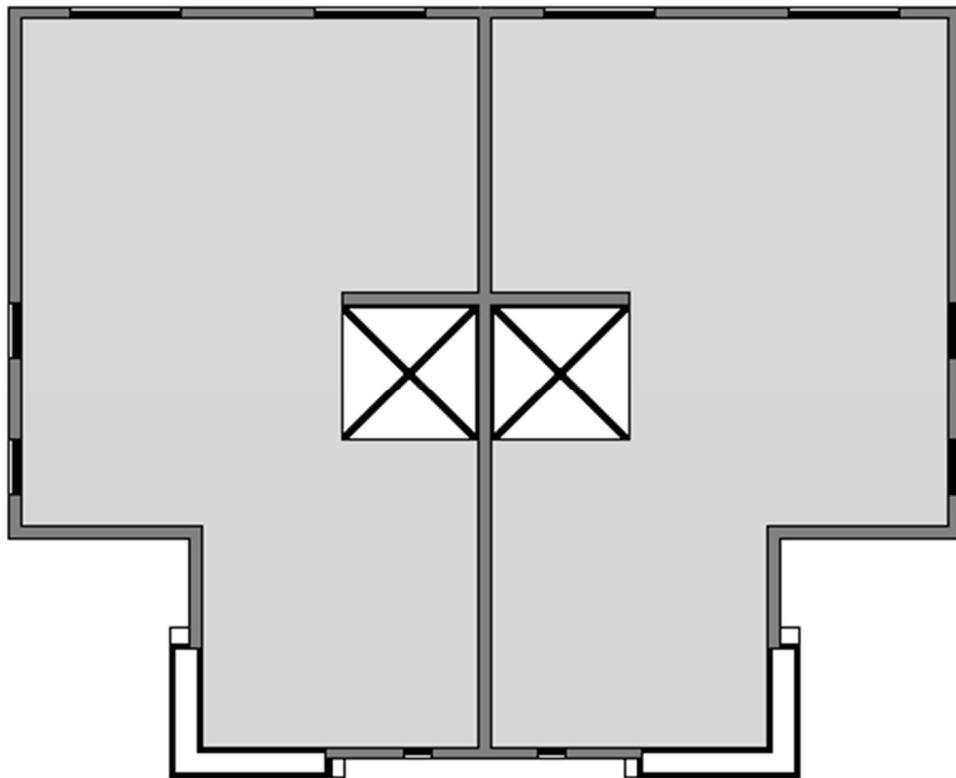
Planta del Segundo Piso del Modelo de Casa B1.
